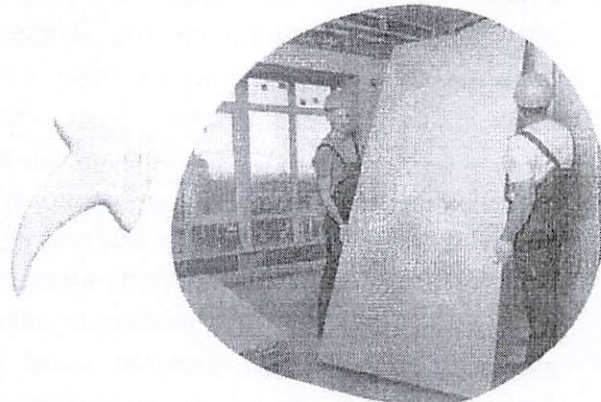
Arquivo Canva - Divisórias Interna (drywall)
